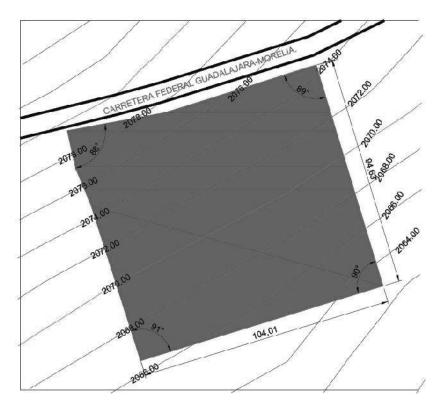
Topografía que presenta el terreno propuesto para la construcción de la U.M.F.
